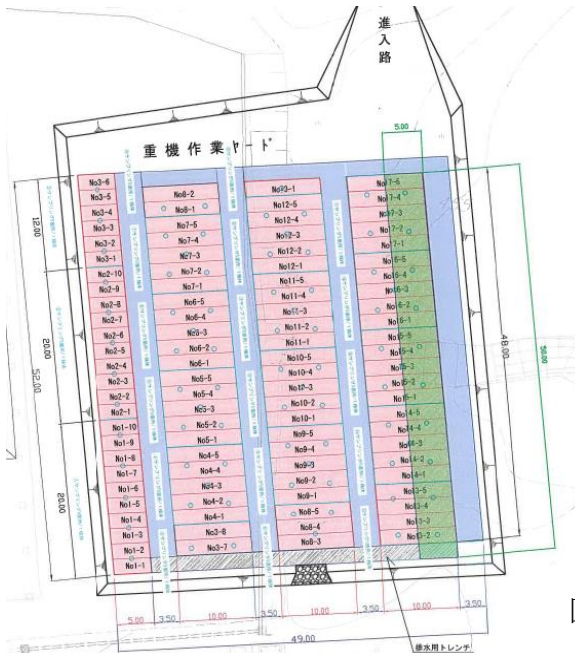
令和元年度3回目洗出し平面図及び外観写真
